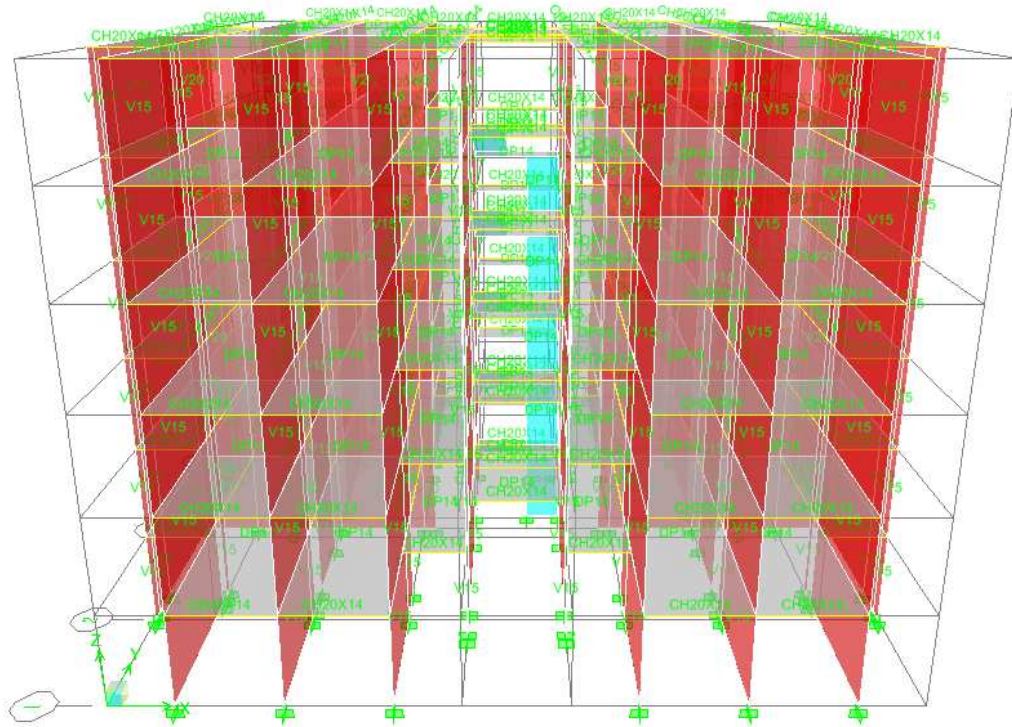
image 3D de la structure (coffrage tunnel) sur ETABS
